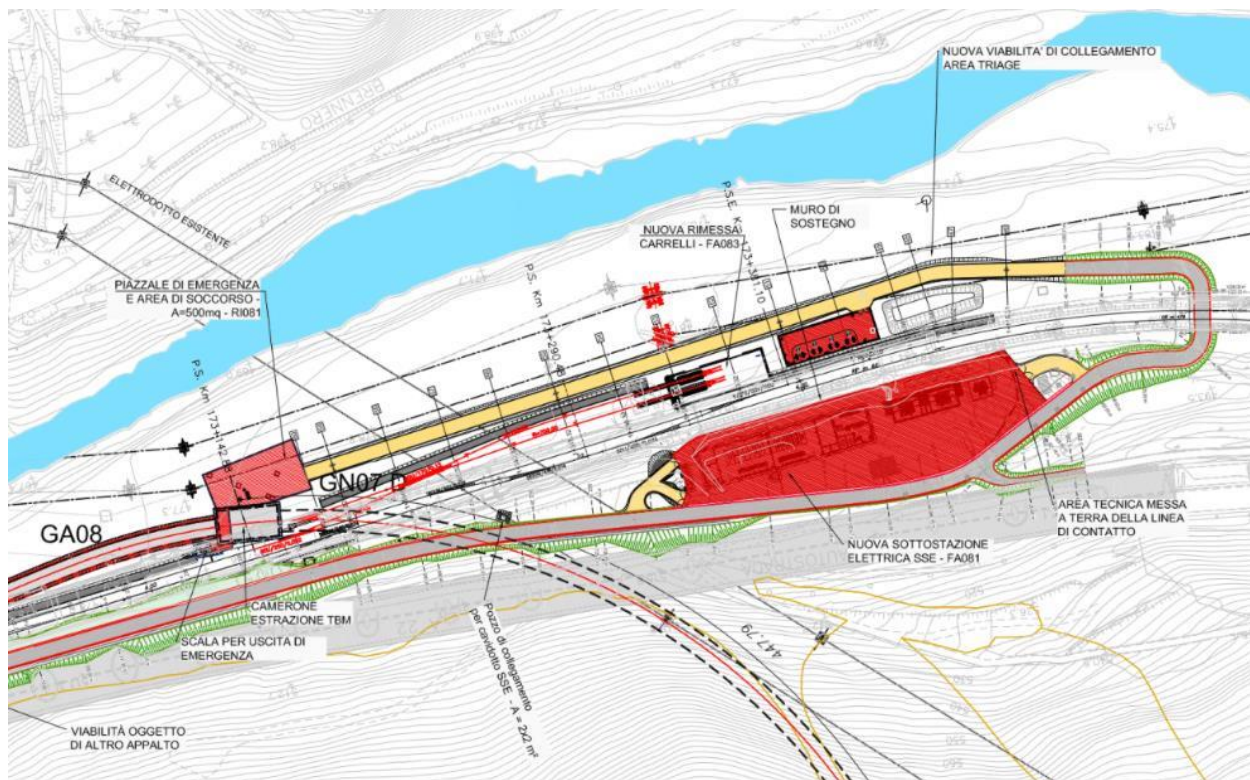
Planimetria di PD in zona Ponte Gardena - configurazione dei tralicci Terna modificata
